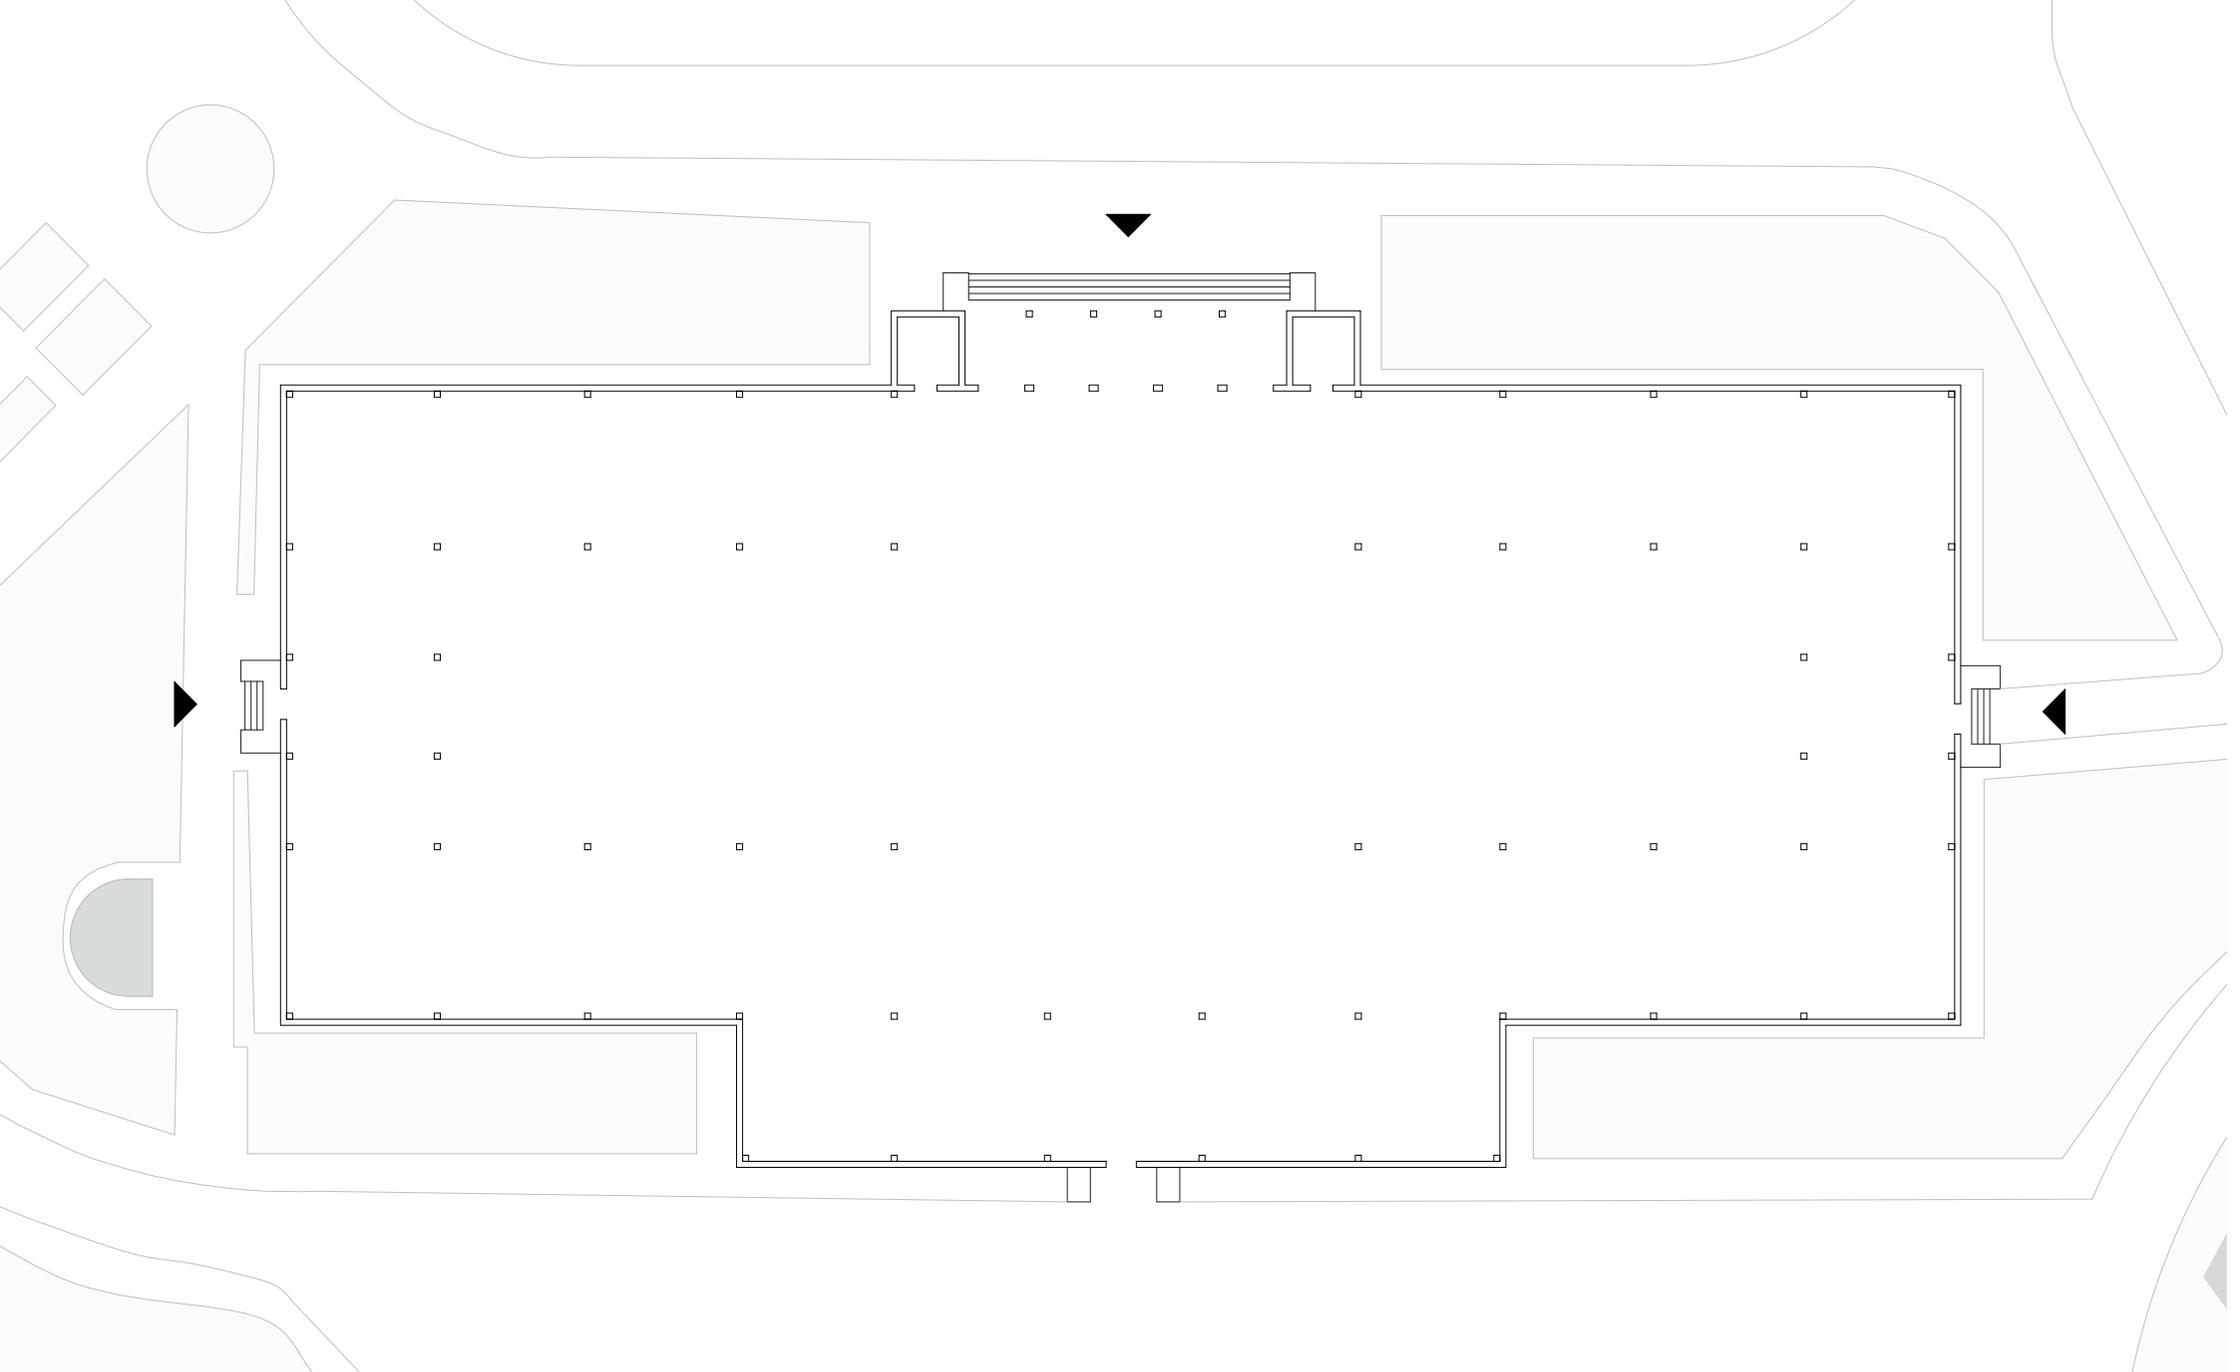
| Grundriss des 3. Pavillons
